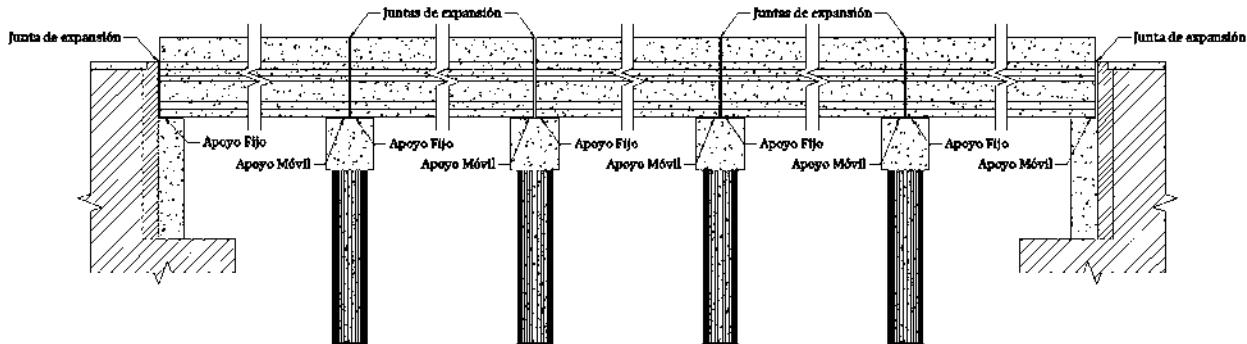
Disposición longitudinal de los apoyos de neopreno
